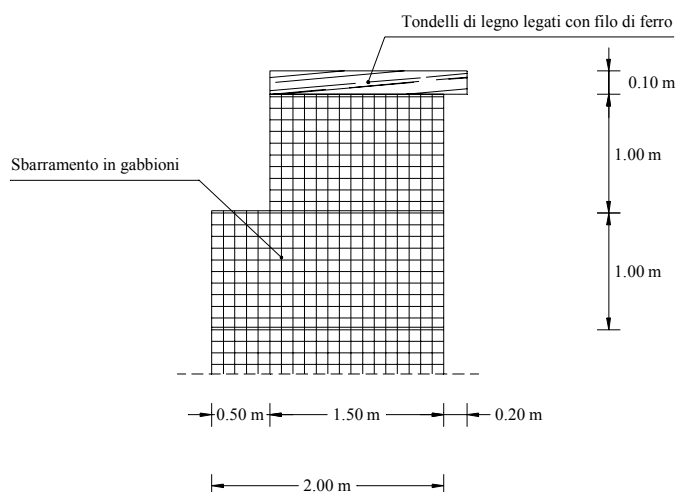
Protezione della gàveta tramite tondelli di legno.
